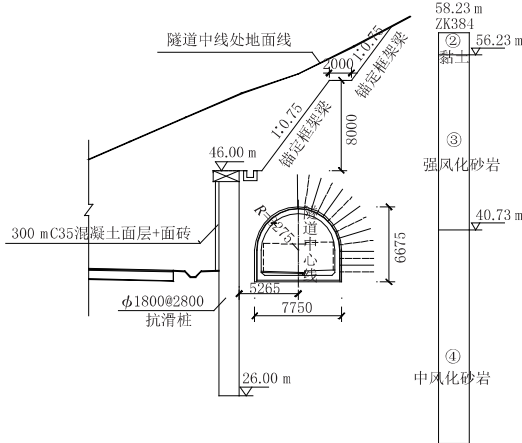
B1 偏压隧道抗滑桩处理断面图(单位: mm)
